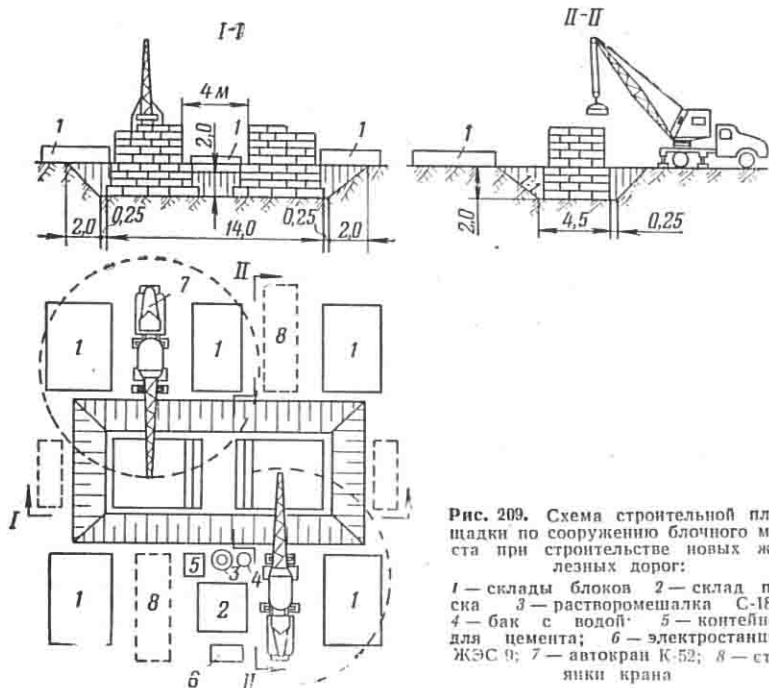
Схема строительной площадки по сооружению блочного моста при строительстве новых железных дорог:
